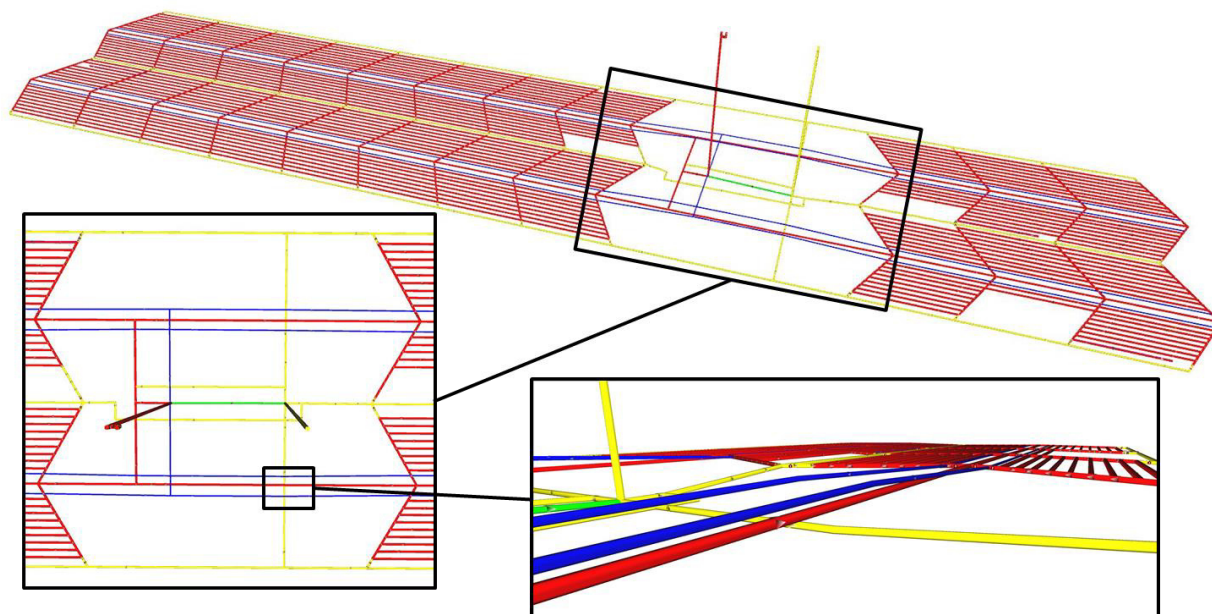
Grubengebäude gesamt mit Draufsicht Zentralbereich und Detailansicht Überführung der Hauptstrecken
